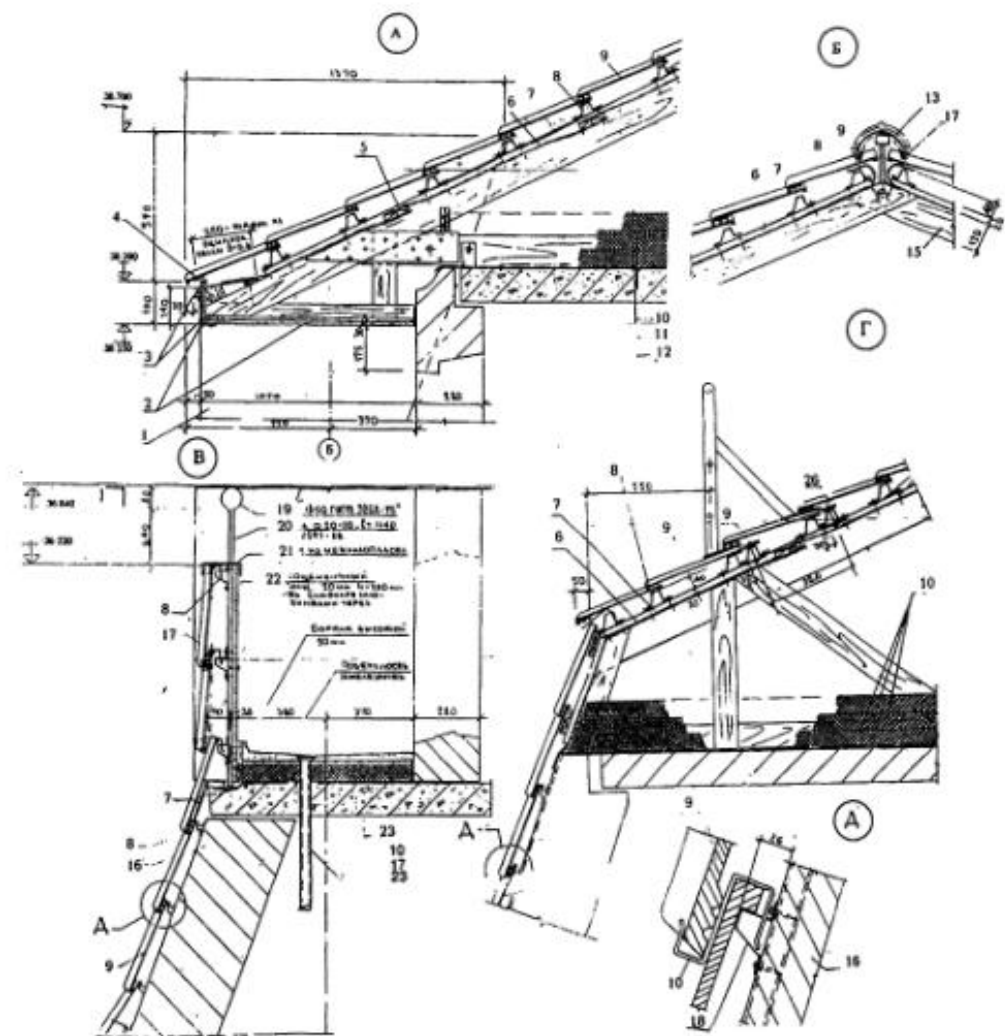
Узлы конструкций мансарды смешанного типа: 1 – торцевая стена лоджии; 2 – водостойкий гипсокартон; 3 – фартук из металлопласта в цвет черепицы; 4 – вентиляционная решетка системы "Брас-ДСК-1"; 5 – вентиляционная решетка нижней защитной пленки; 6 – защитная пленка; 7 – контробрешетка; 8 – обрешетка из оцинкованного профиля шагом 320 мм; 9 – цементная черепица фирмы "Брас-ДСК-1"; 10 – утеплитель; 11 – пароизоляция; 12 – железобетонная панель перекрытия; 13 – коньковый элемент; 14 – гидроизоляция, переходящая с плиты лоджии под черепицу; 15 – стропильная нога; 16 – панель наружной стены; 17 – гидроизоляция, переходящая с плиты лоджии под черепицу; 18 – клямера для крепления и навески черепицы на крутых скатах; 19 – труба  $d = 80$  мм; 20 – стойка квадратного сечения  $20 \times 20$  мм; 21 – фартук из металлопласта; 22 – асбестоцементный лист  $\delta = 20$  мм; 23 – армированная стяжка из цементно-песчаного раствора с заглаженной поверхностью; 24 – панель перекрытия лоджии; 25 – труба водоотвода с лоджии; 26 – оцинкованная стальная планка, крепится болтами к дополнительным листам обрешетки; 27 – закладной элемент железобетонной панели (труба  $d = 20$  мм) для крепления стальных профилей обрешетки
